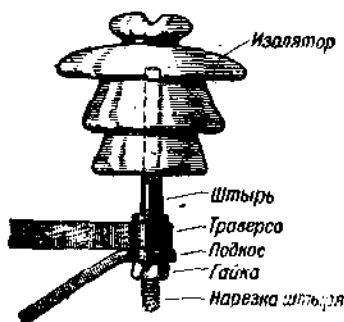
Крепление провода на траверсе анкерной деревянной АП-образной опоры
